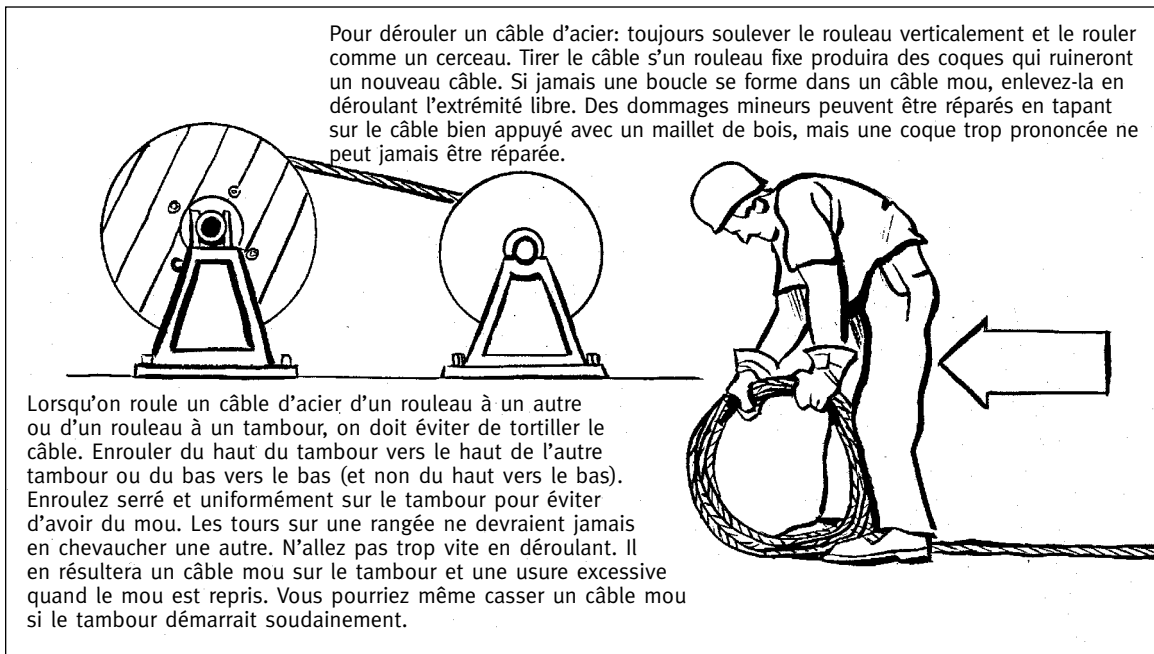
Enrouler un câble d'acier sur un tambour et dérouler un câble d'acier
